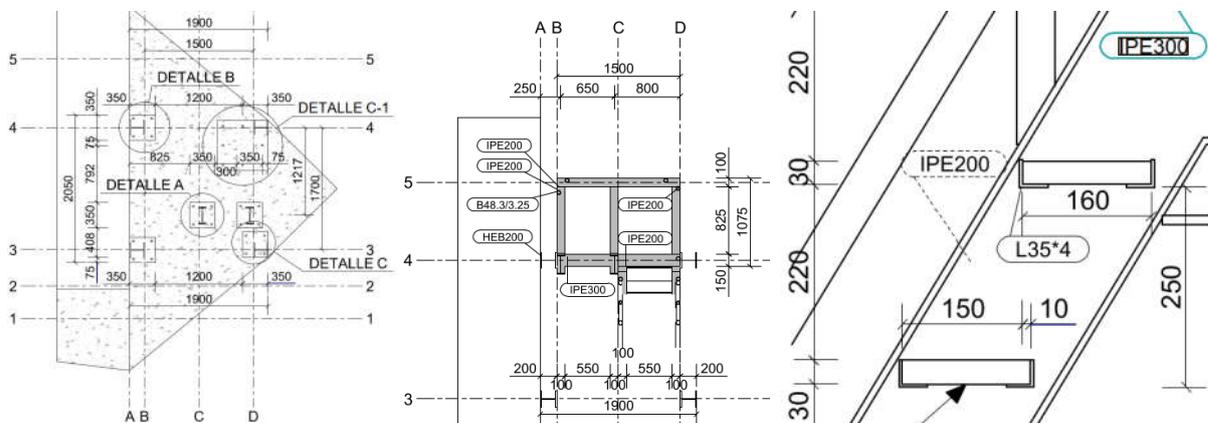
Planta de cimentación y descansillo, así como detalle de zancas
